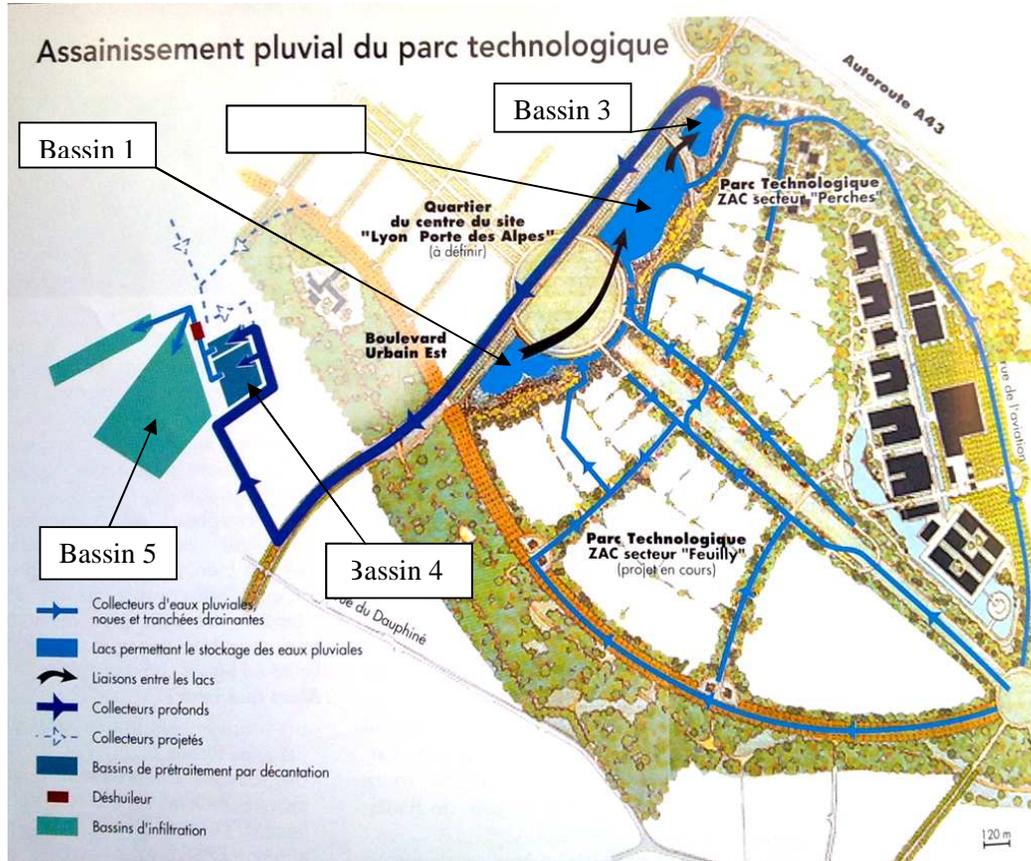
Plan de l'assainissement pluvial à la Porte des Alpes
